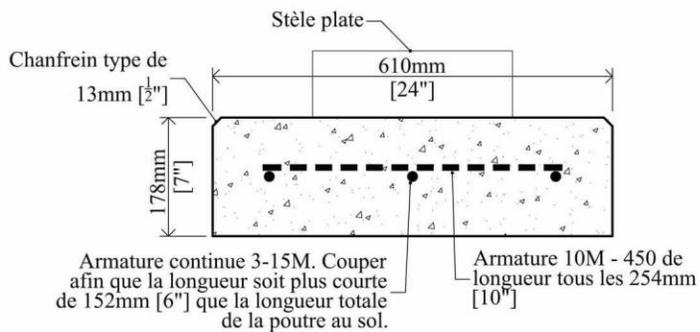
(ii) : Poutre de fondation au sol pour stèles plates multiples et stèles commandées spécialement – poutre apparente.
